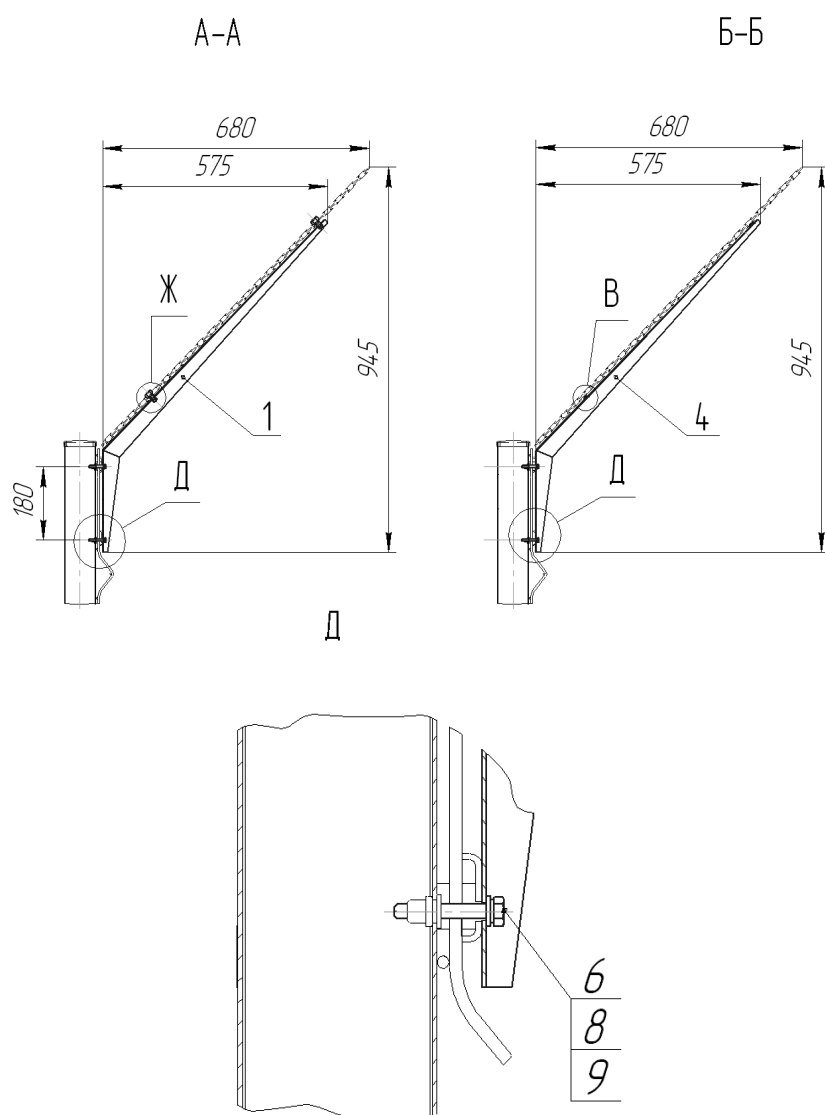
Разрезы А-А, Б-Б, детальный вид Д
